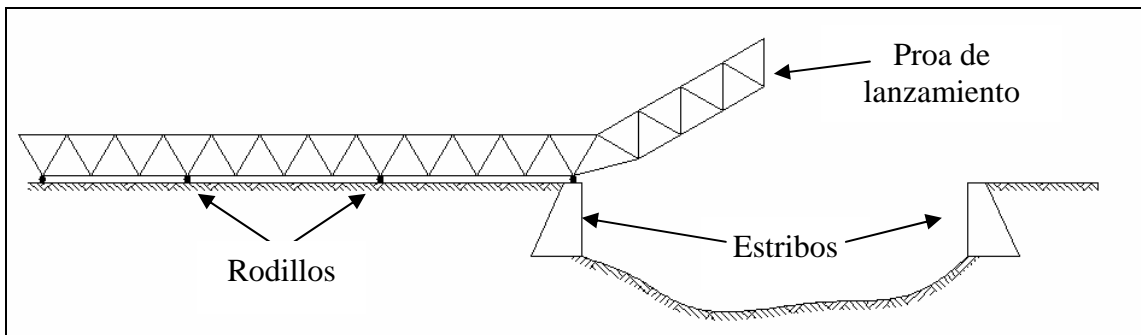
Ensamblaje de las armaduras en la orilla.
